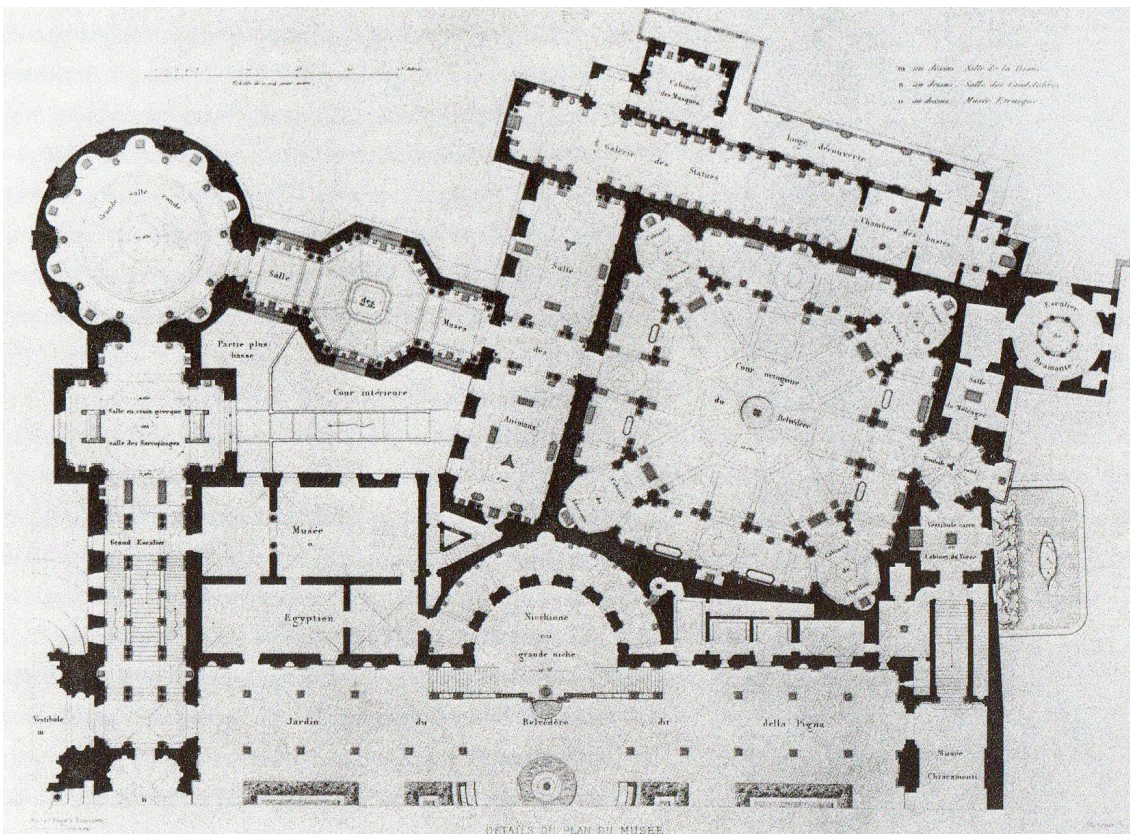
Donato Bramante, Statuenhof im Belvedere und Museo Pio-Clementino, Grundriss, Stich nach Paul Letarouilly: Le Vatican, Paris 1882
